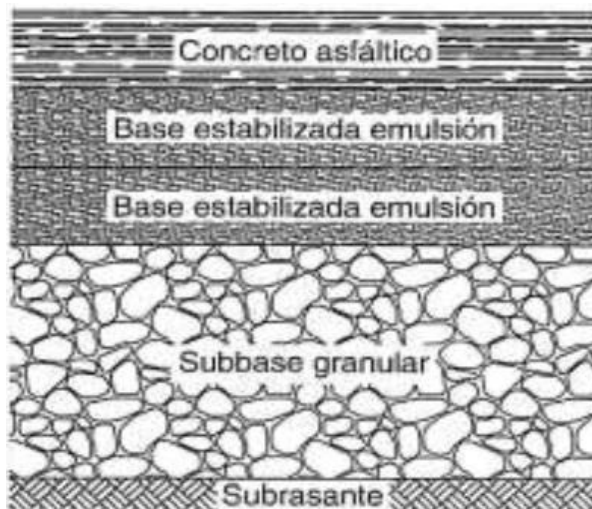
Estructura Típica de Pavimento Semi- rígido. Fuente: (Rondón & Reyes, 2015)
